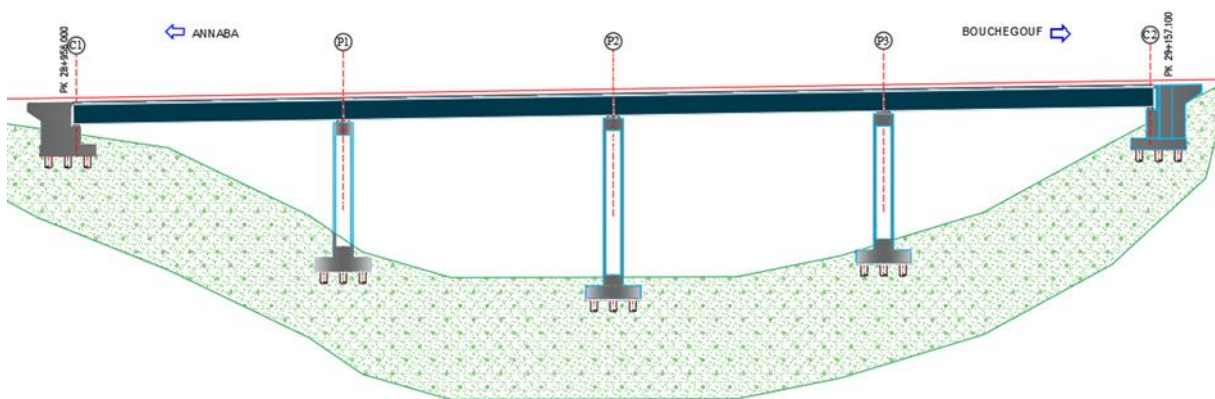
schéma statique de la variante PONT MIXTE BIPOUTRE
